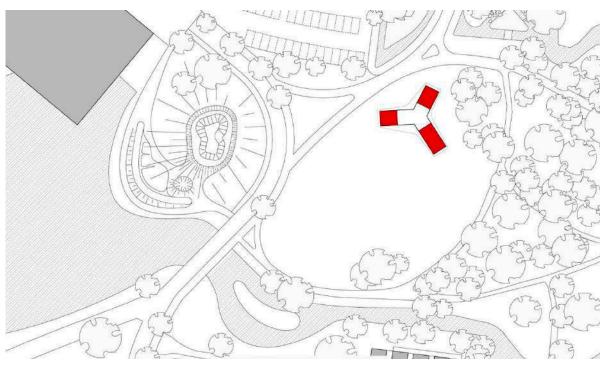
Casa de Té, Países bajos, plano de conjunto (recuperado en archdaily).
